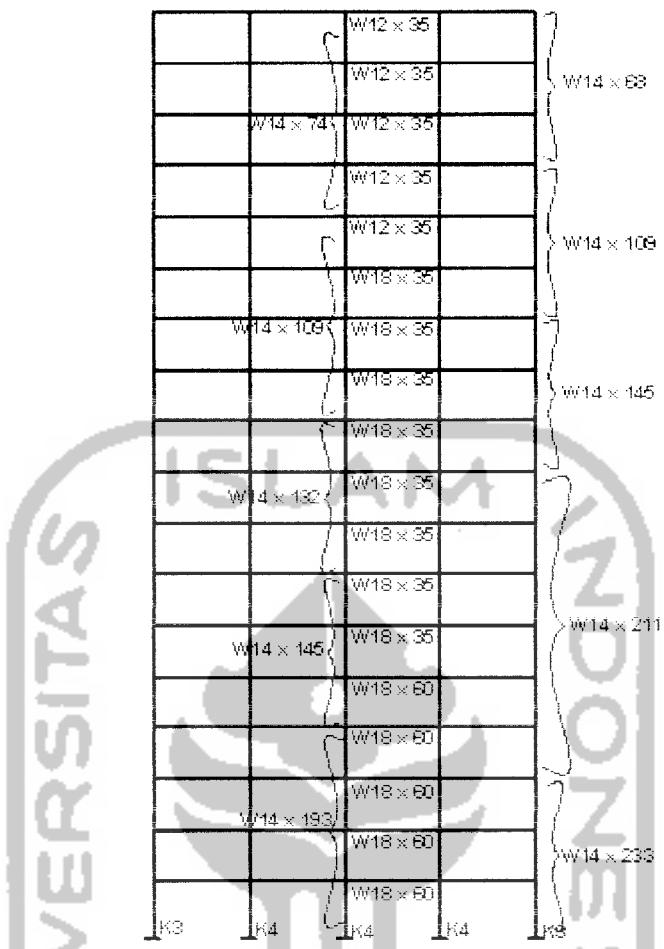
Denah Struktur Dengan Menggunakan Kolom Baja Komposit
